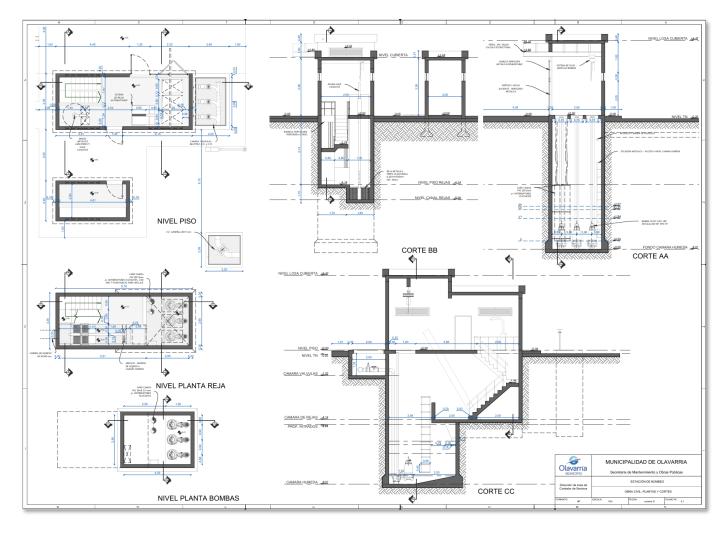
Plano Planta y Cortes de la Estación de Bombeo.
